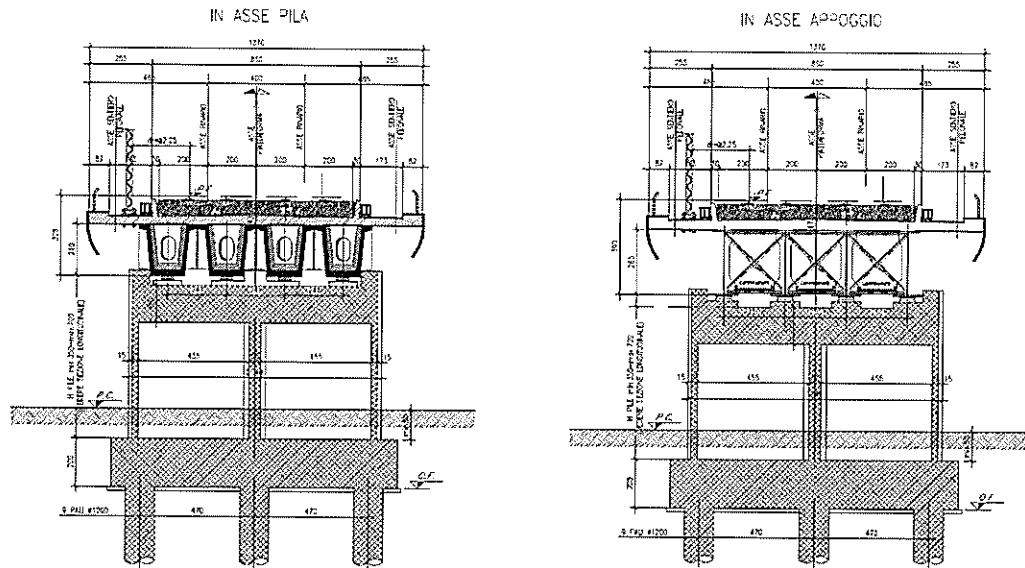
Pila campate 25 - 40 m: sezioni trasversali in asse pila e in asse appoggi
